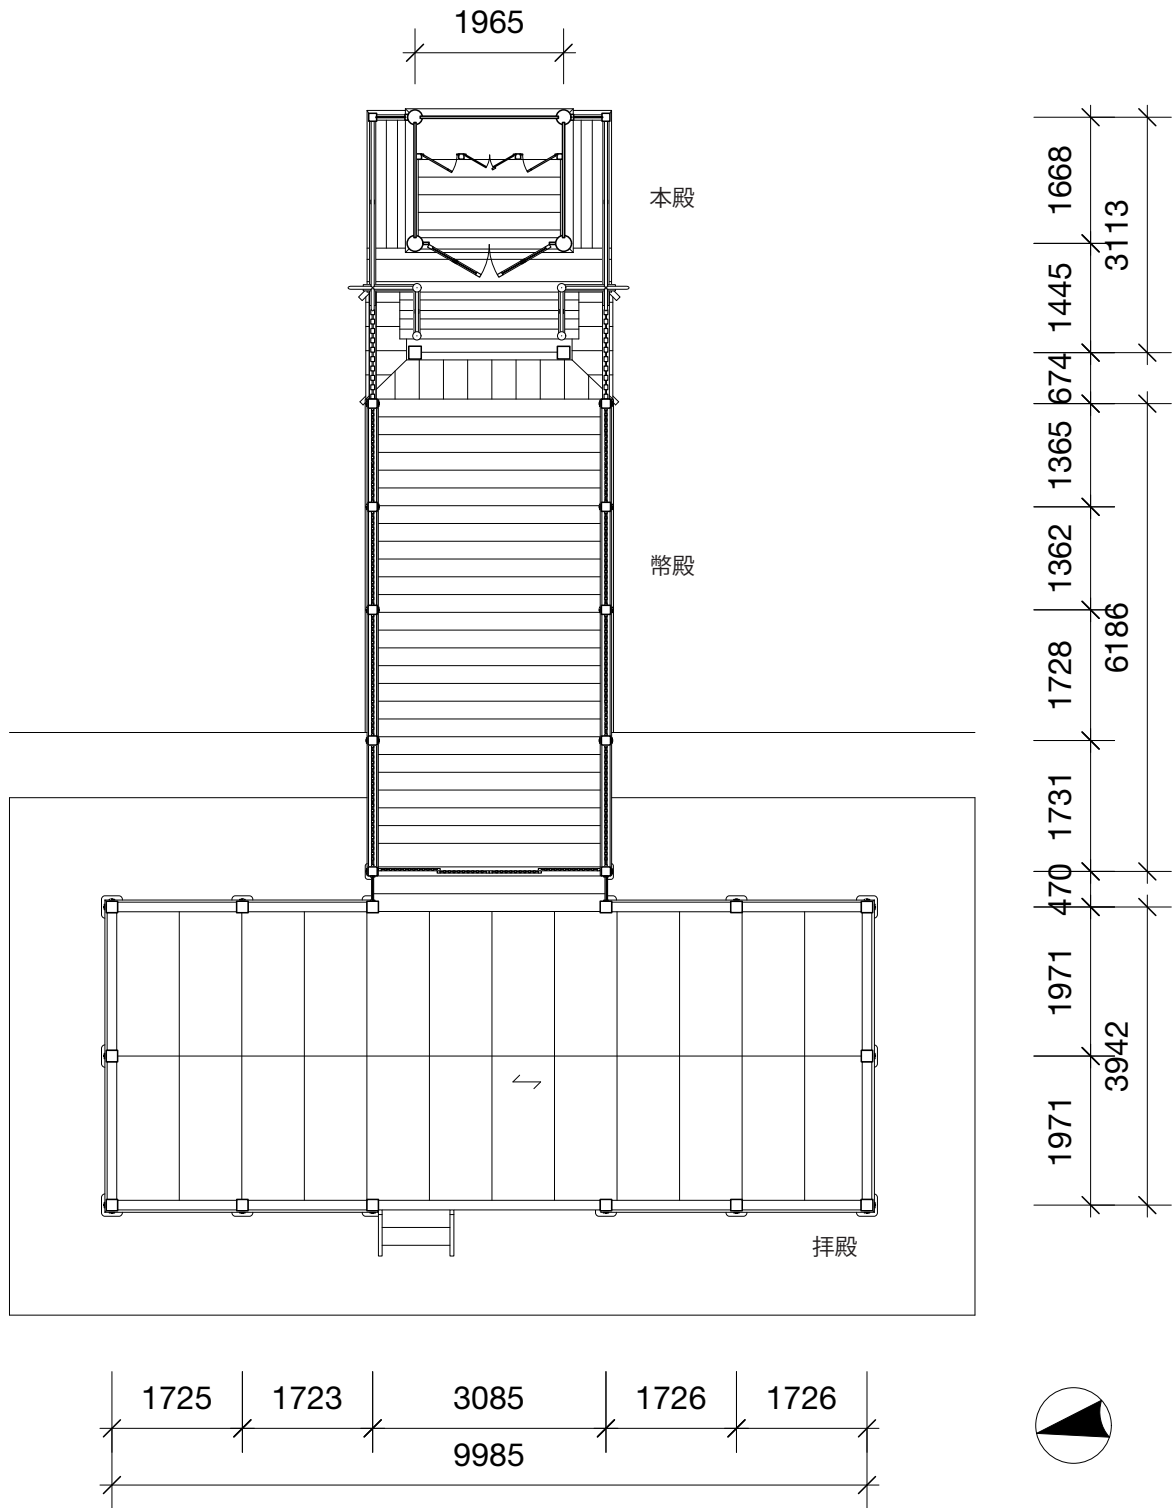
五霊神社本殿・幣殿・拝殿平面図(1/100)
